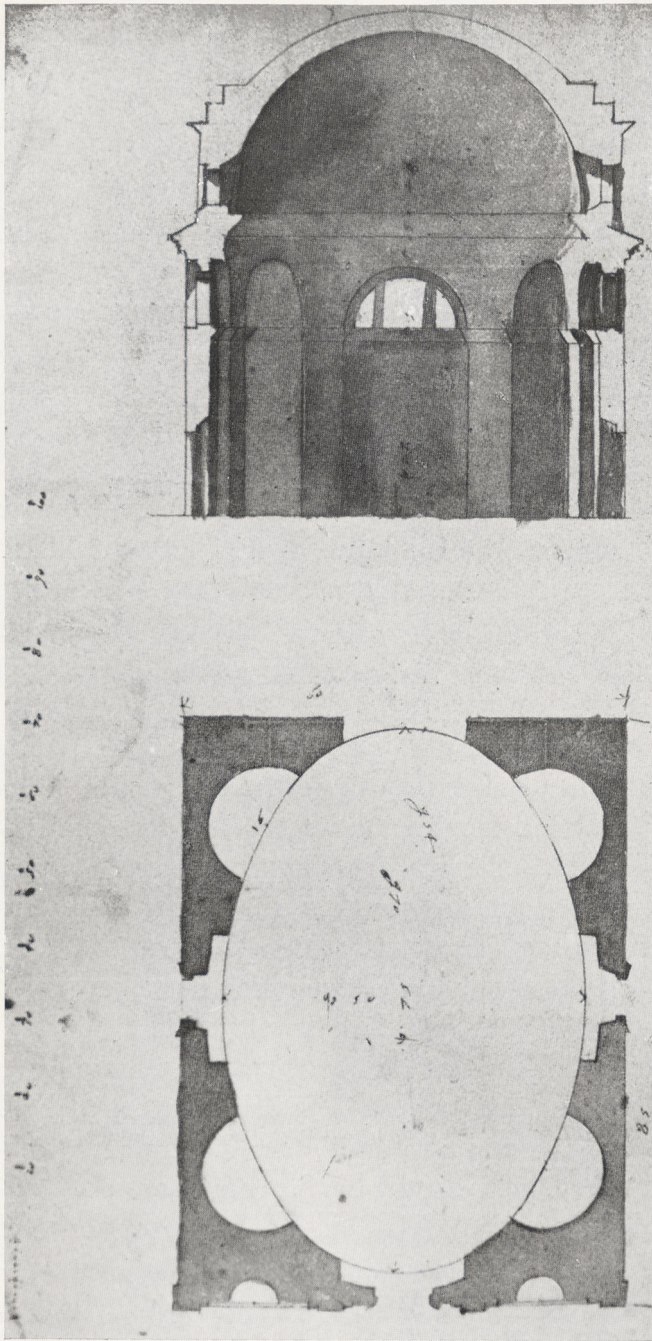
Vignola, Projekt für Ovalbau. Parma, Staatsarchiv
